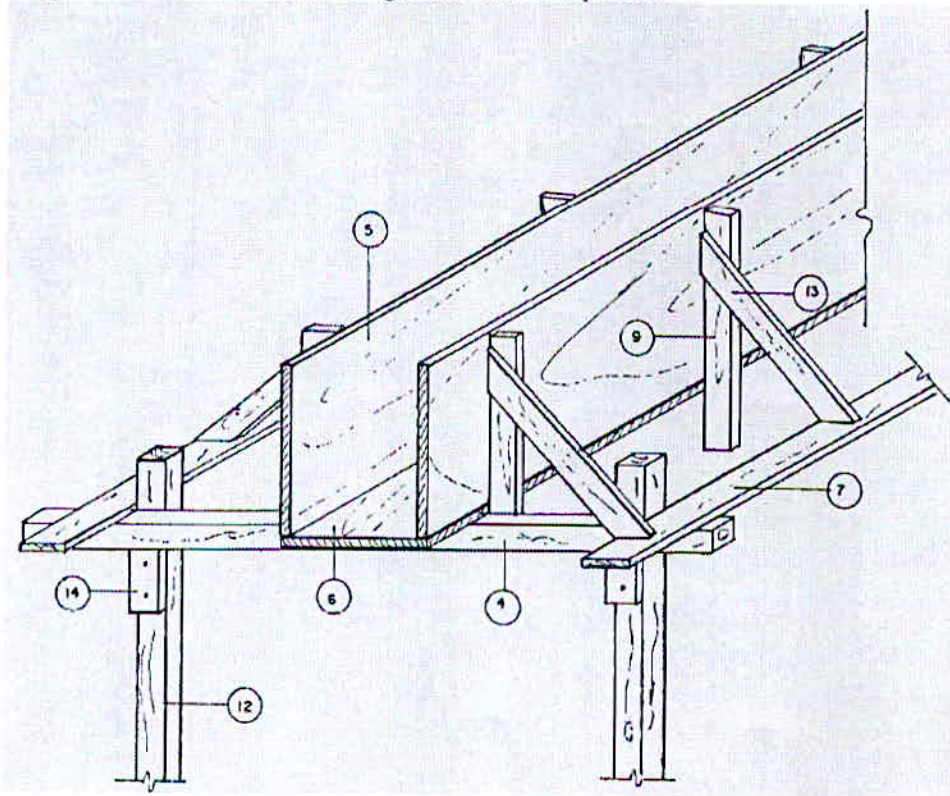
Detalhe de fôrma de vigas de pequena dimensão.
